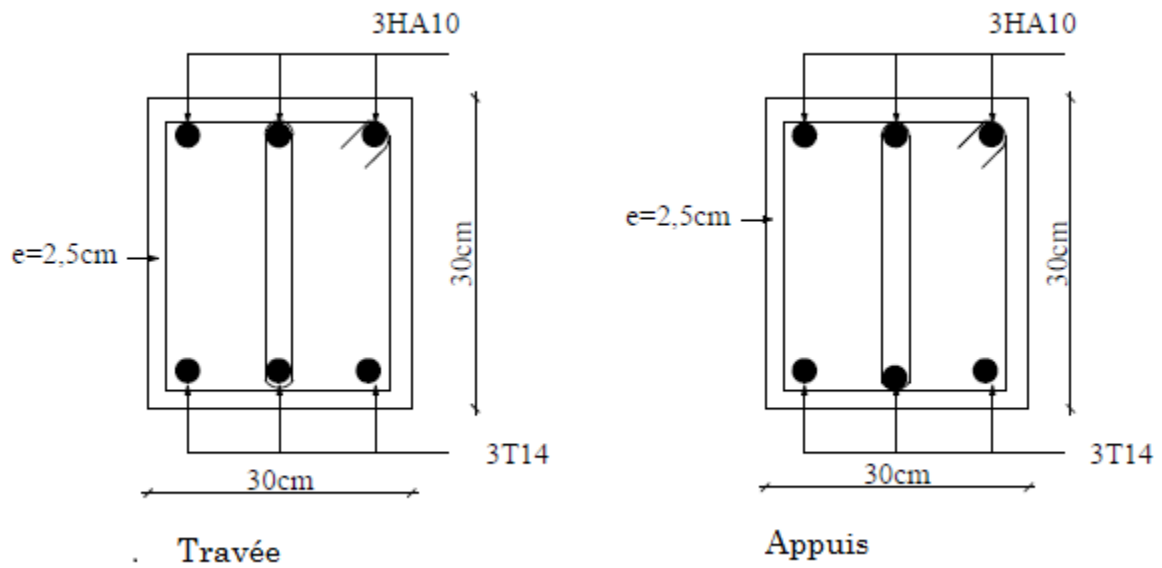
Schéma de ferrailage de la poutre de chaînage
